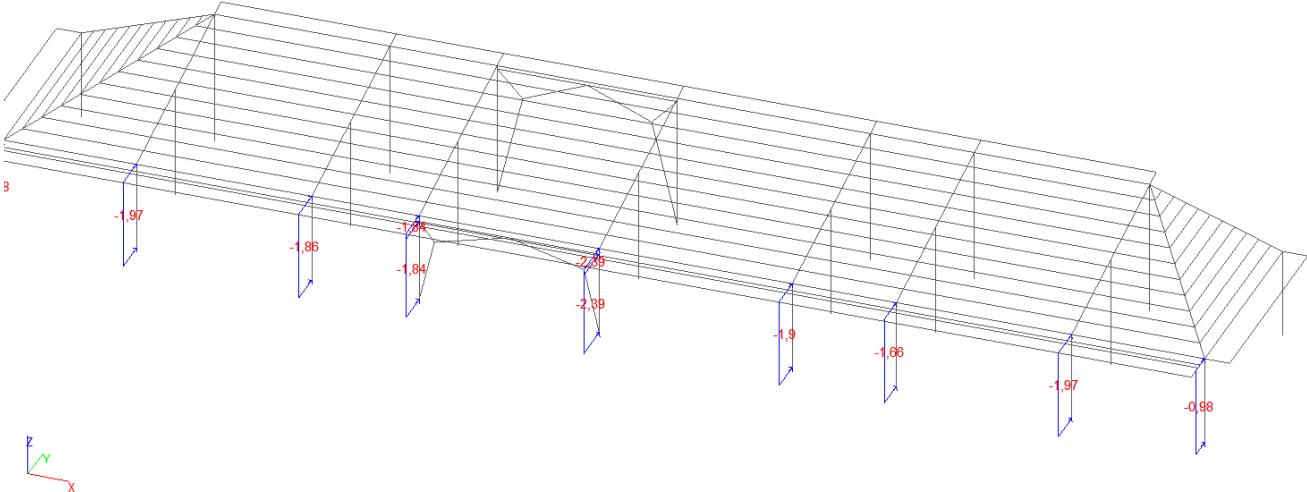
Схема загружения каркаса расчётной ветровой нагрузкой
